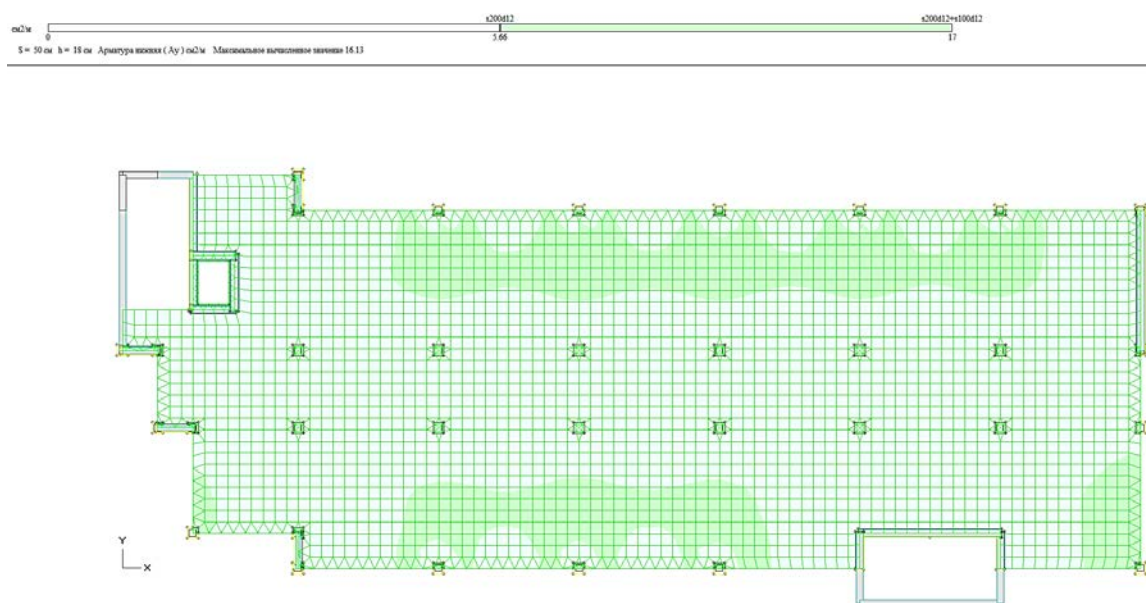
Расчетное нижнее армирование по оси Y
